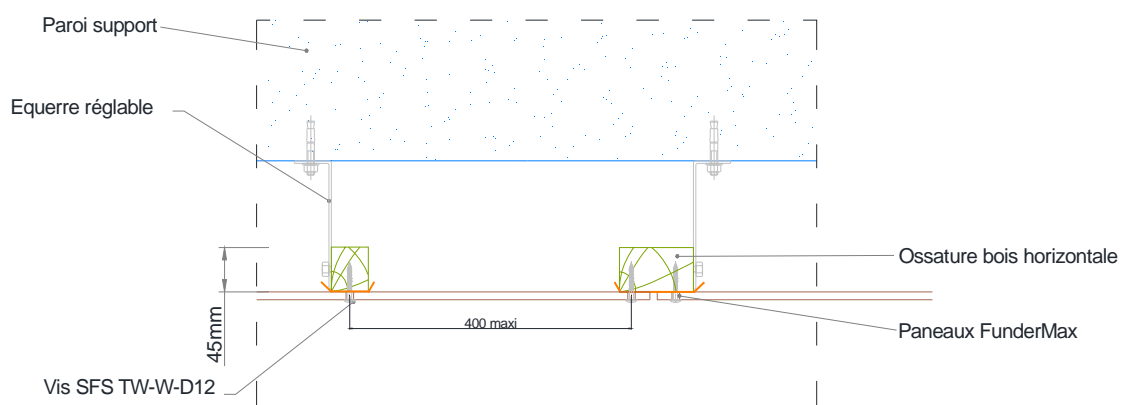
Pose en sous-face – Coupe verticale sans isolant
